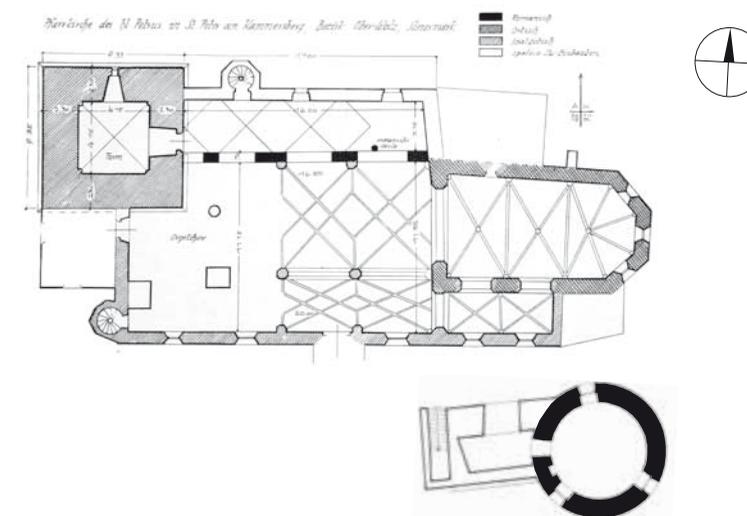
Baualterplan der Kirche in Sankt Peter am Kammersberg mit dem Rundkarner N° 45 im Südosten des Kirchenschiffes, M 1:500. Klaar 1954, BDA Planarchiv Wien.
